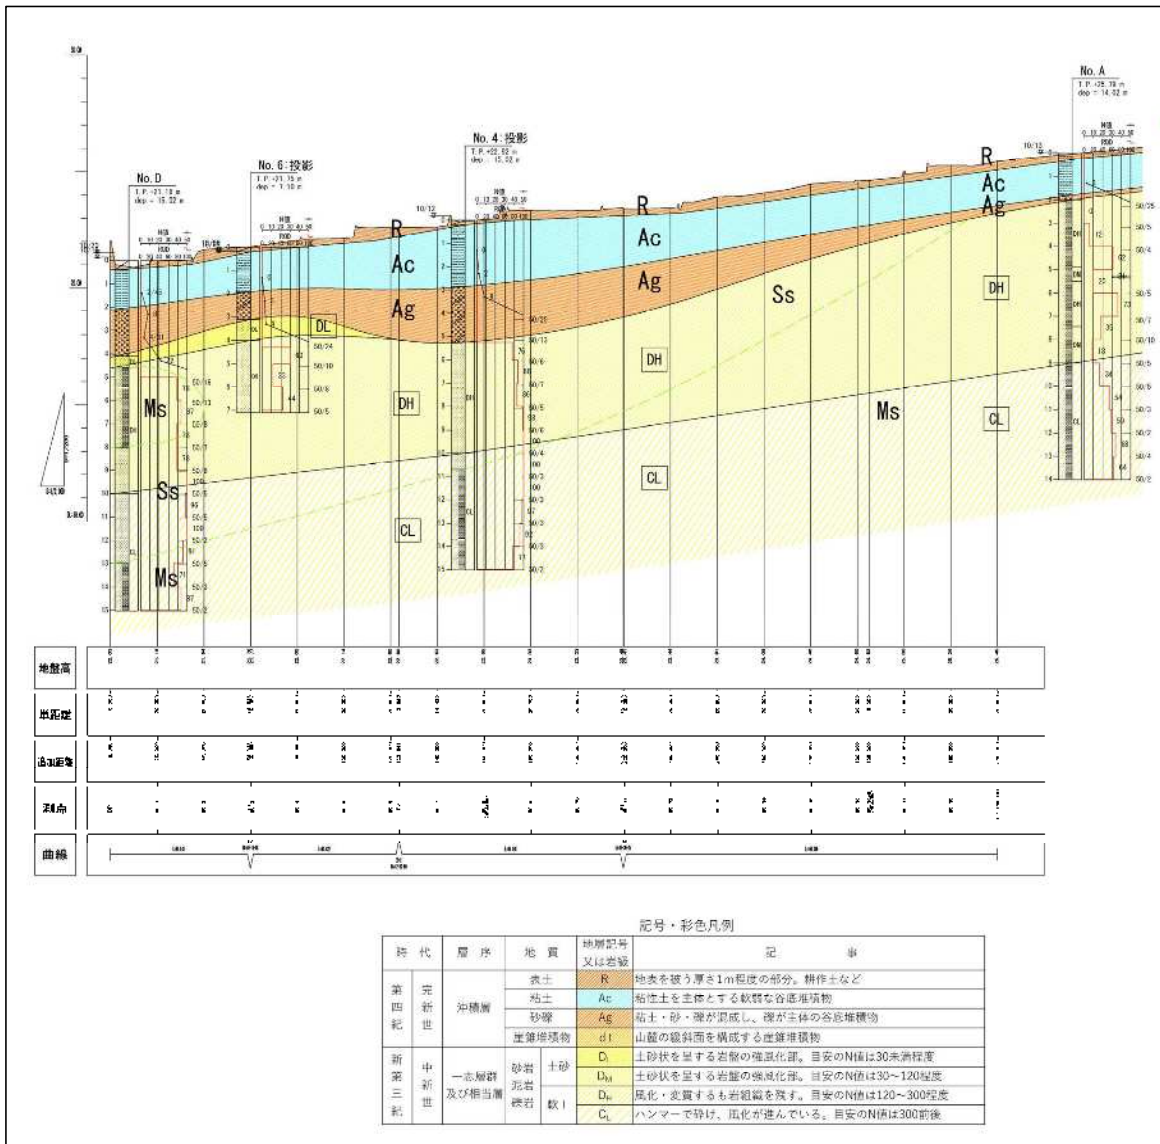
(1) ボーリング調査位置図及び推定地質断面図
